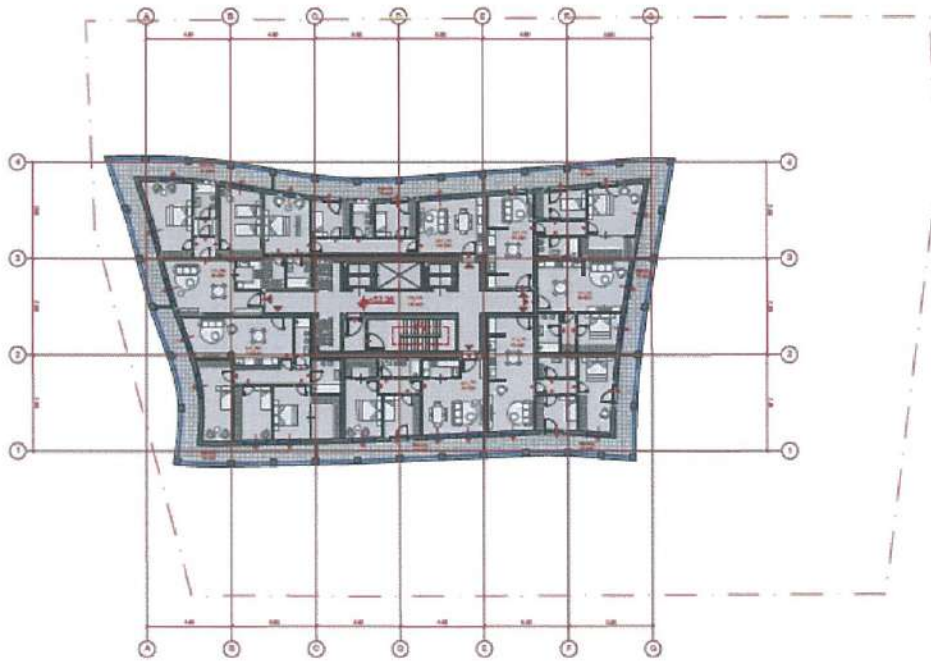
Planimetria e katit 13, në kuotën +52.36 SIP 960 m²
